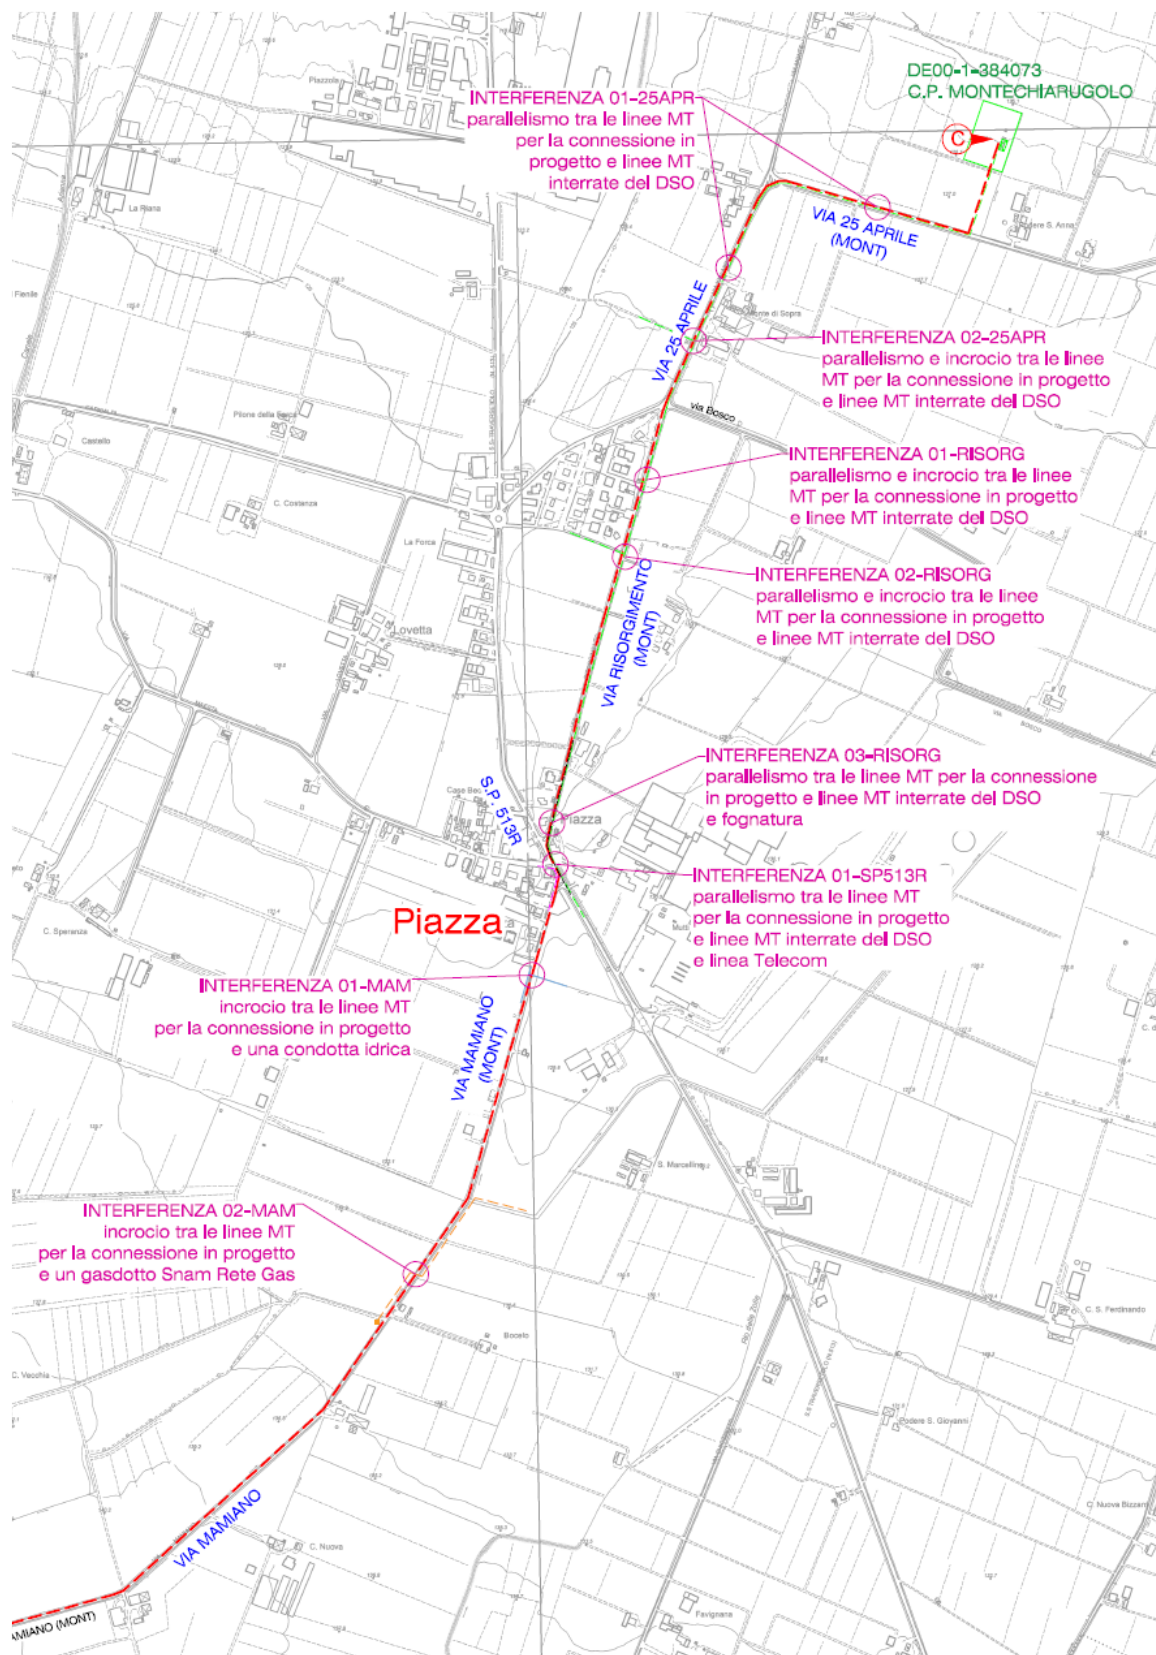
Stralcio planimetria dalle cabine di consegna verso la cabina primaria (secondo tratto)
